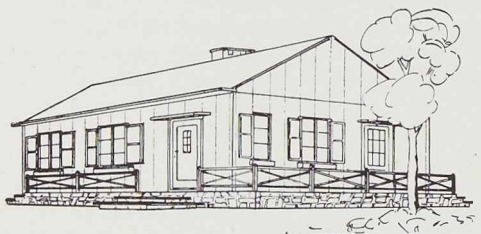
Maison préfabriquée construite par les Ateliers de Construction de Jambes-Namur.
